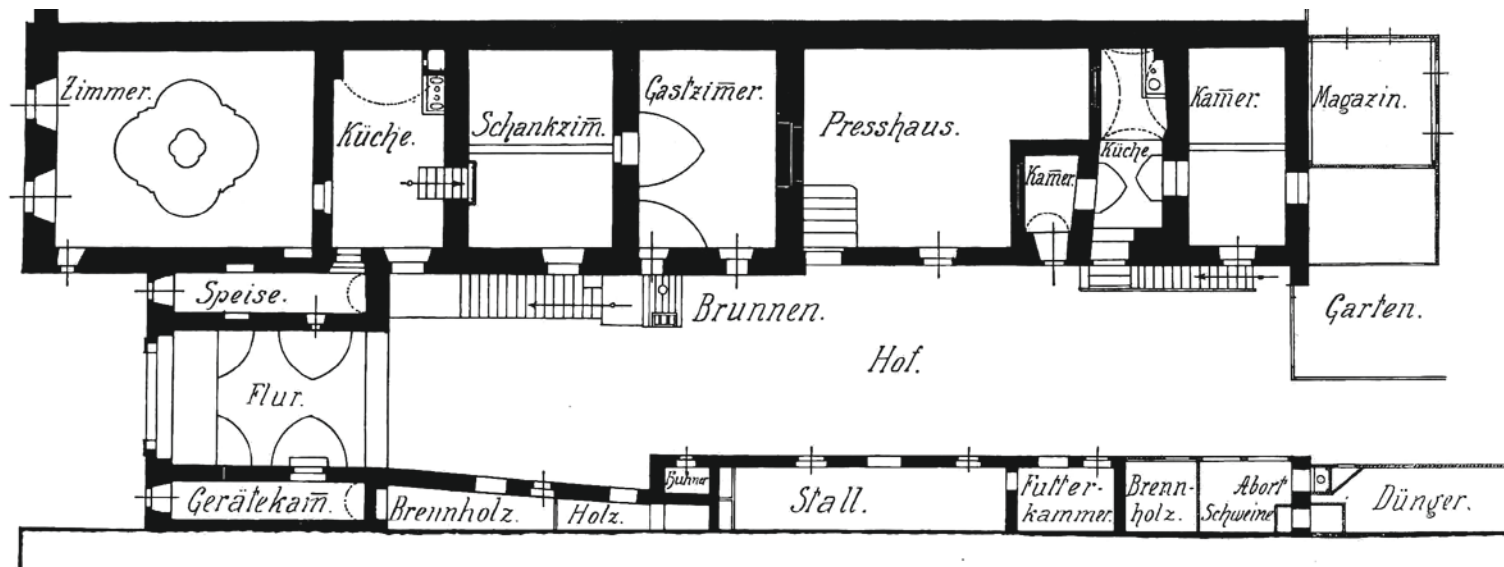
Weinhauerhaus Kahlenbergerstraße, Grundriss und Fotografien 1907/1913
